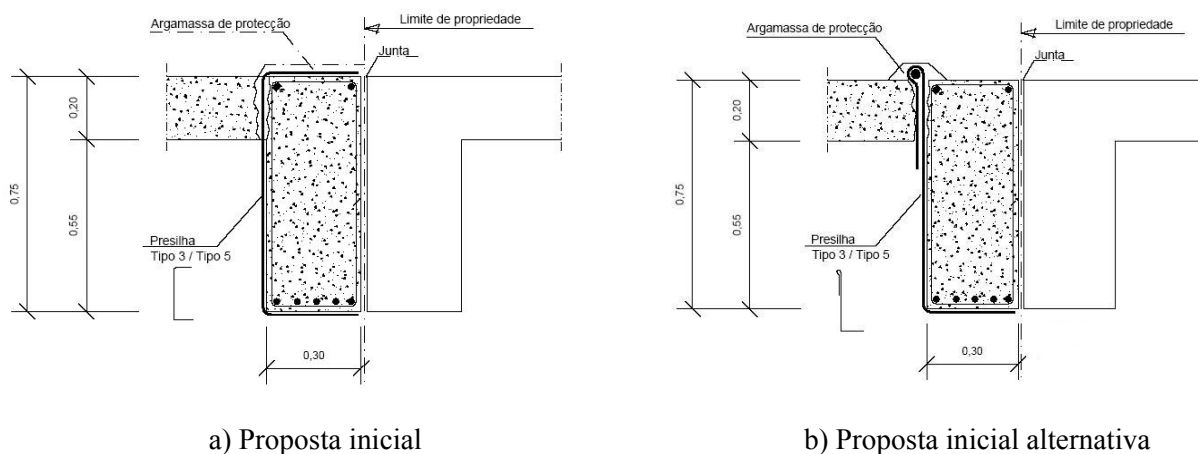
Propostas iniciais para reforço ao corte das vigas do pórtico 8 e 15
